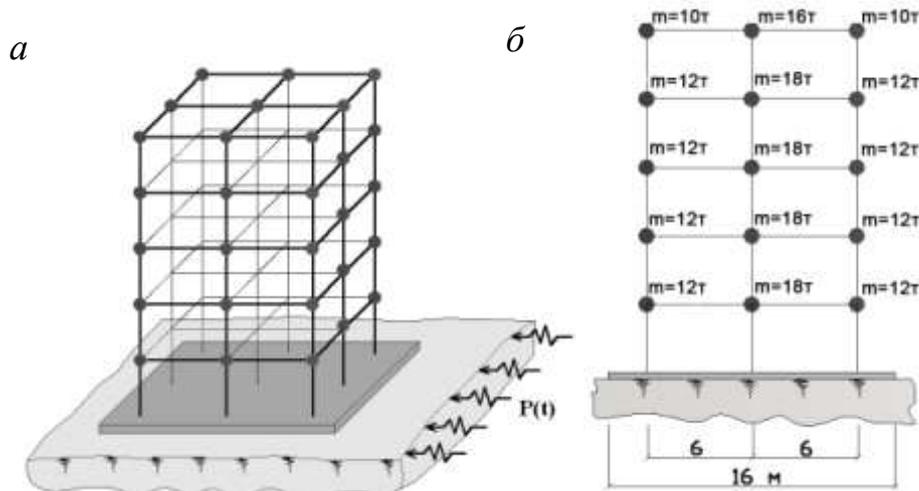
Пространственная расчетная схема 5-этажного каркасного здания на ПФП: *а* – общий вид; *б* – массы в узлах рам здания
